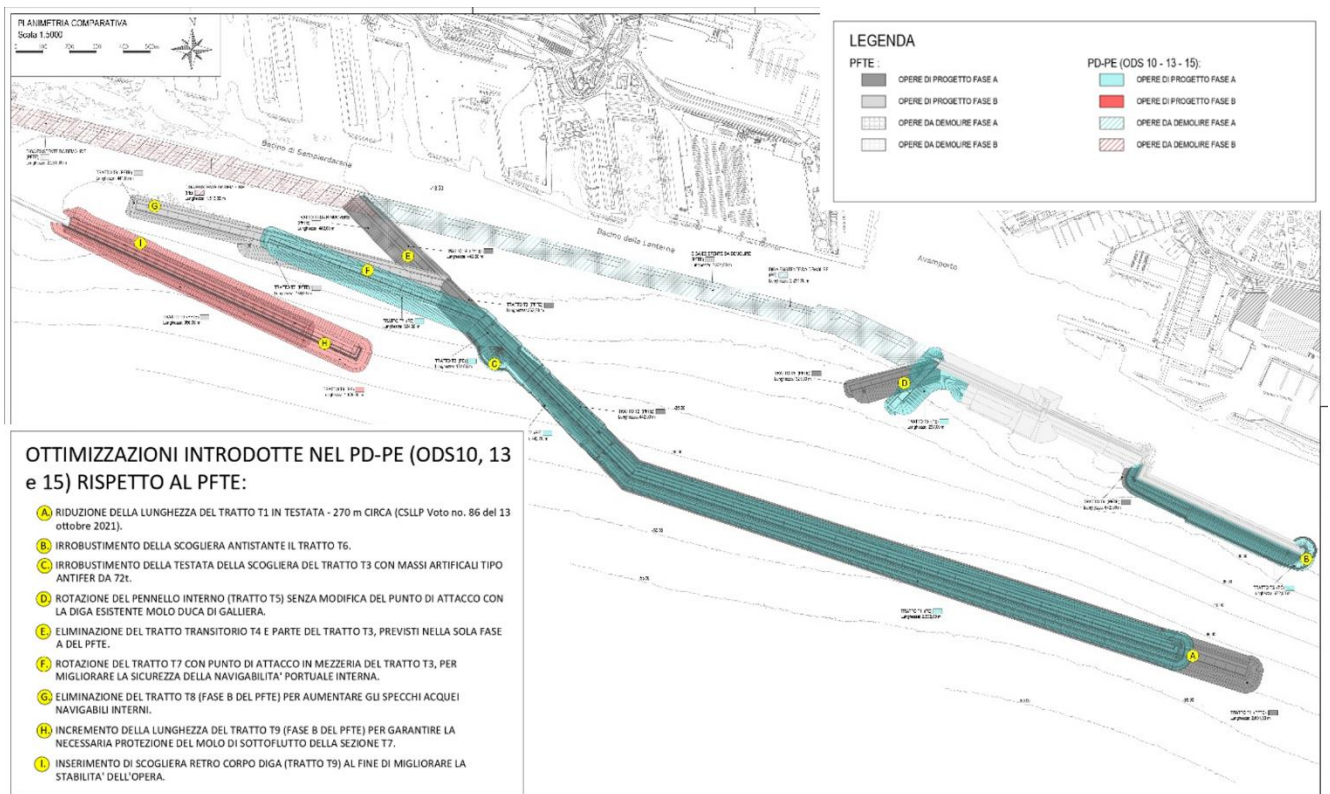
Planimetrica generale comparativa Layout PFTE e Layout finale
